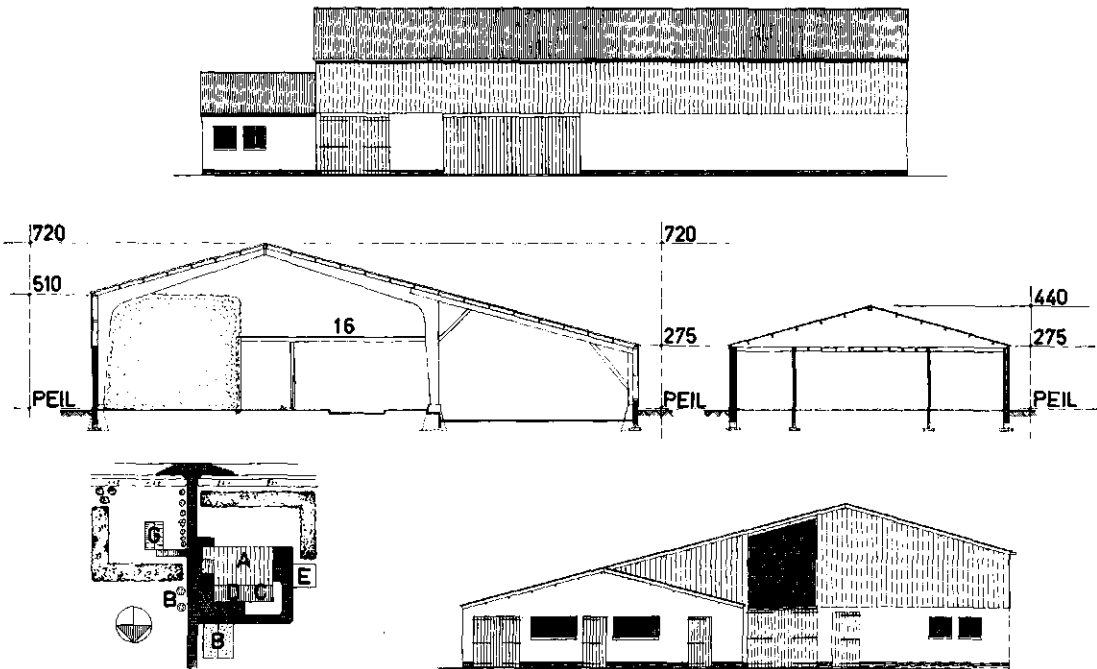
Plan F: gevels, doorsneden, erfindeling
